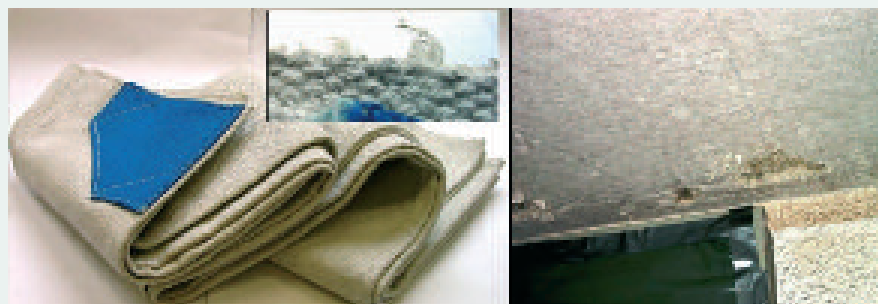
Löschdecke und Spritzasbest mit schwachgebundenem Asbest
